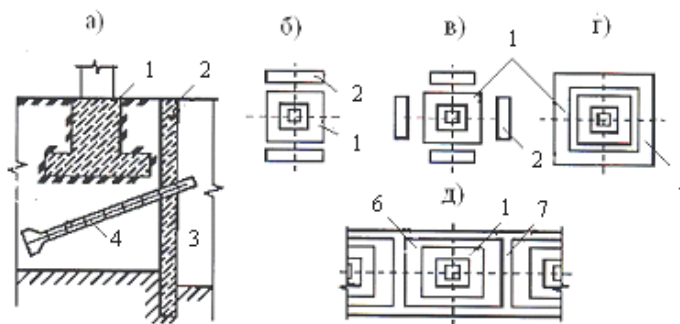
Схемы усиления отдельно стоящих фундаментов способом «стена в грунте»:
